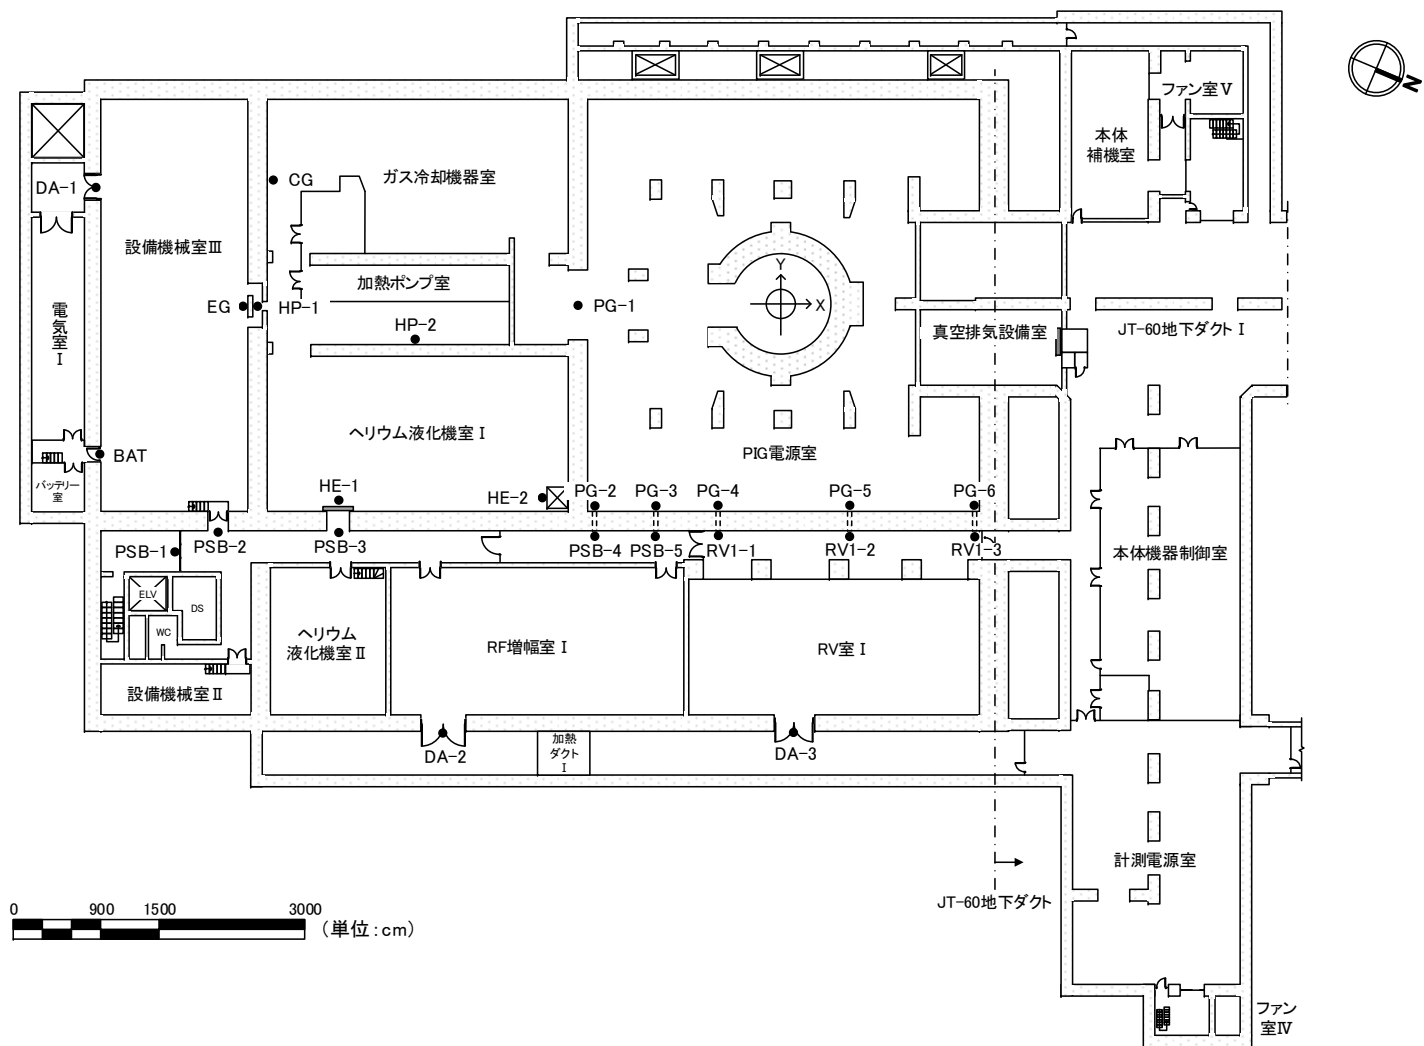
1. 5. 5 JT-60実験棟地階平面図 (単位: cm)
